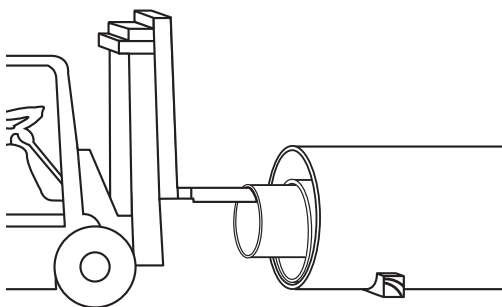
Desembalaje de tubos anidados con el brazo de izado protegido de una carretilla elevadora
